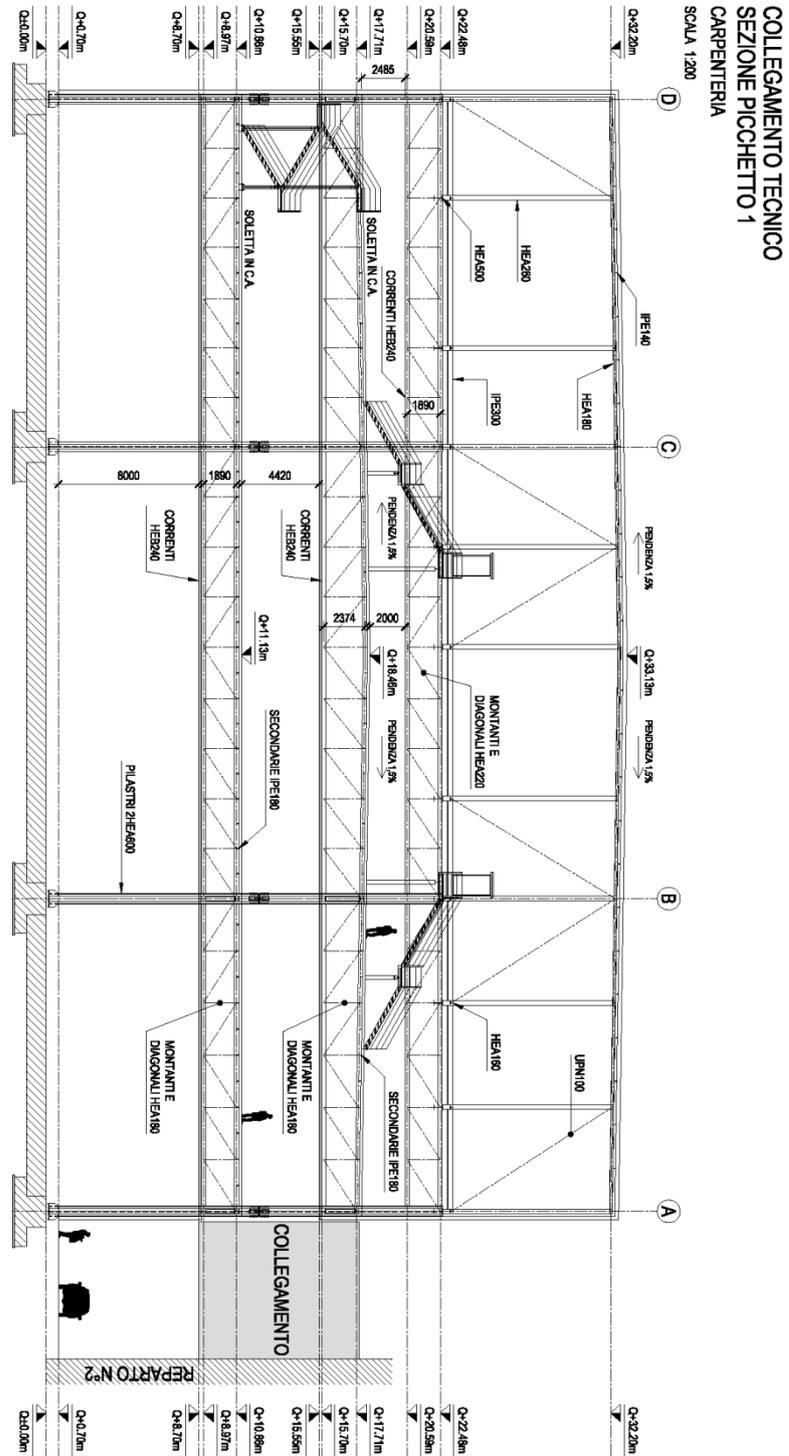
Sezione longitudinale tipo struttura di elevazione
